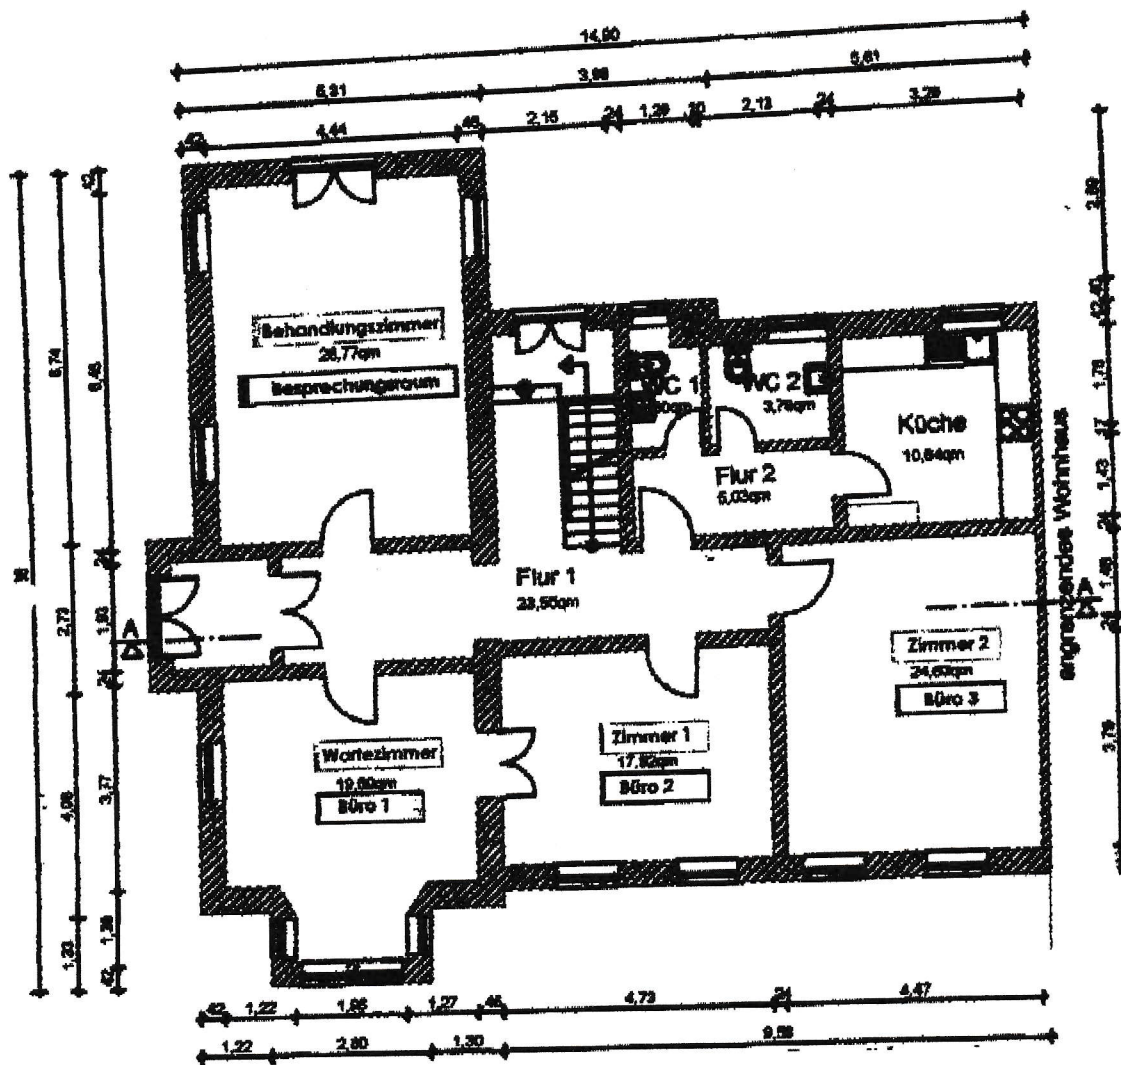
Grundriss Erdgeschoß, Hostatostrasse 26, 65929 Frankfurt am Main
